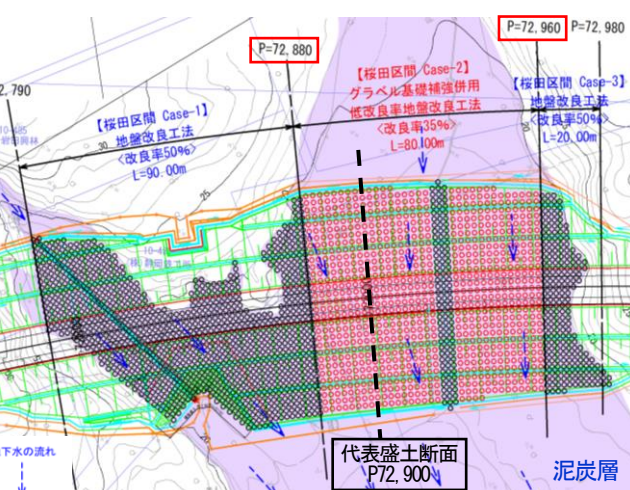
当該盛土区間の対策工平面図 (P72,790～72,980)
